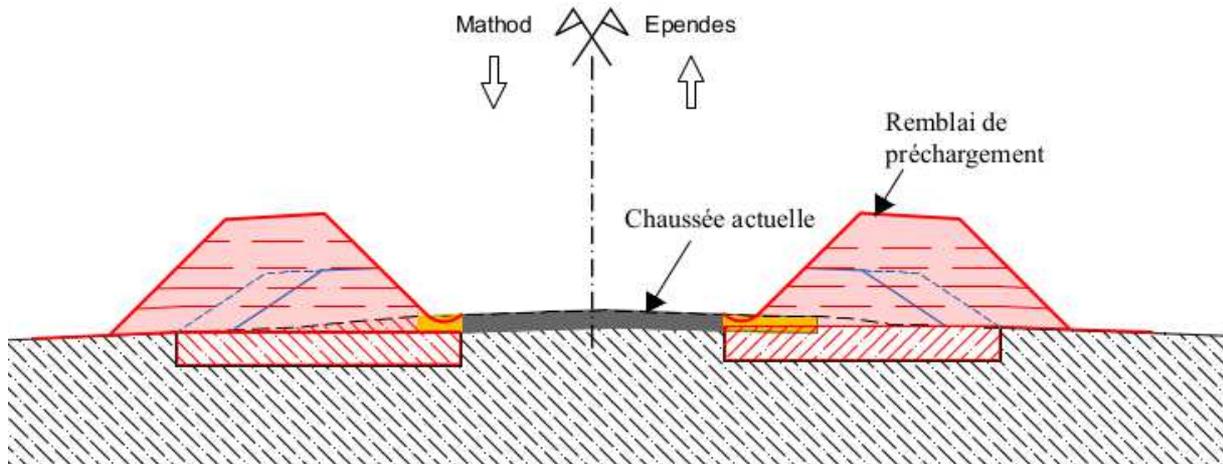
Coupe sur rampe d'accès du pont sur le Mujon avec remblais de préchargement (route ouverte)
